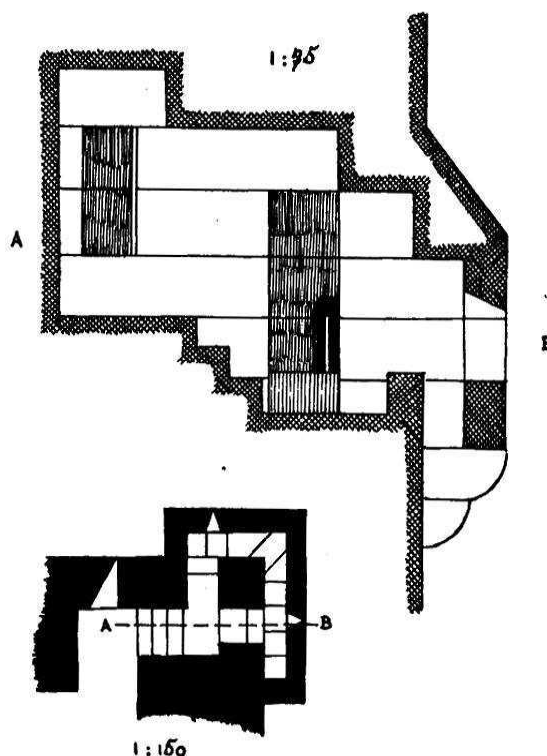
Tour I : plan et coupe d'une bretèche d'angle.
